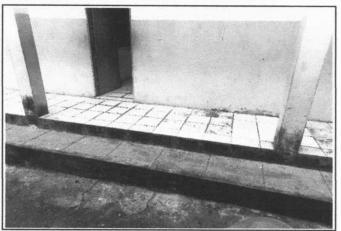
SUBSTITUIÇÃO DE PISOS
